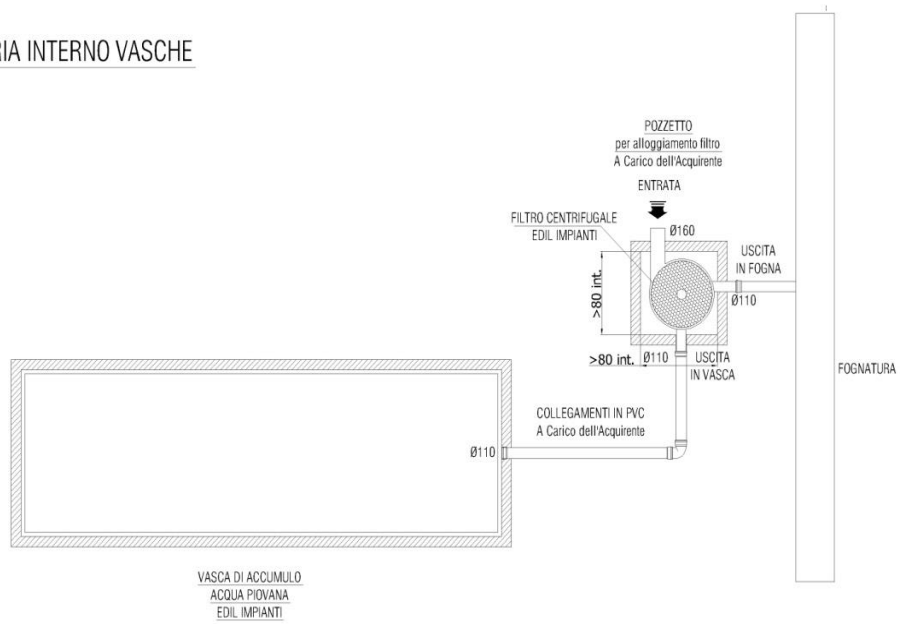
Planimetria vasca recupero acque da pioggia
